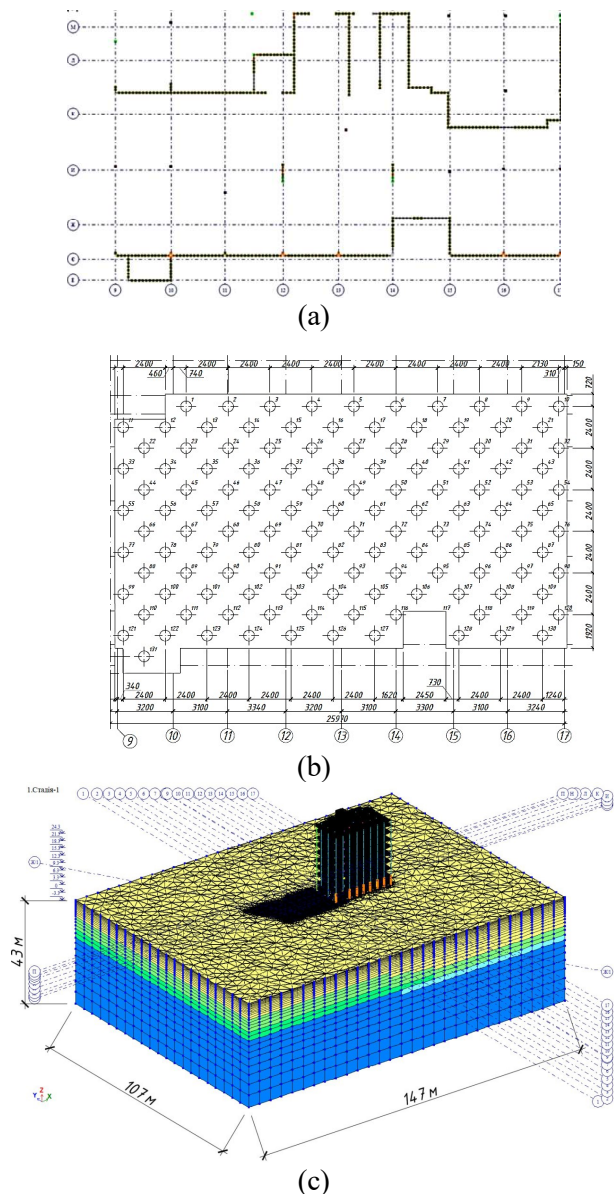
Задача №2: (a) – план вертикальних несучих елементів; (b) – план фундаментів; (c) – SE-модель.
